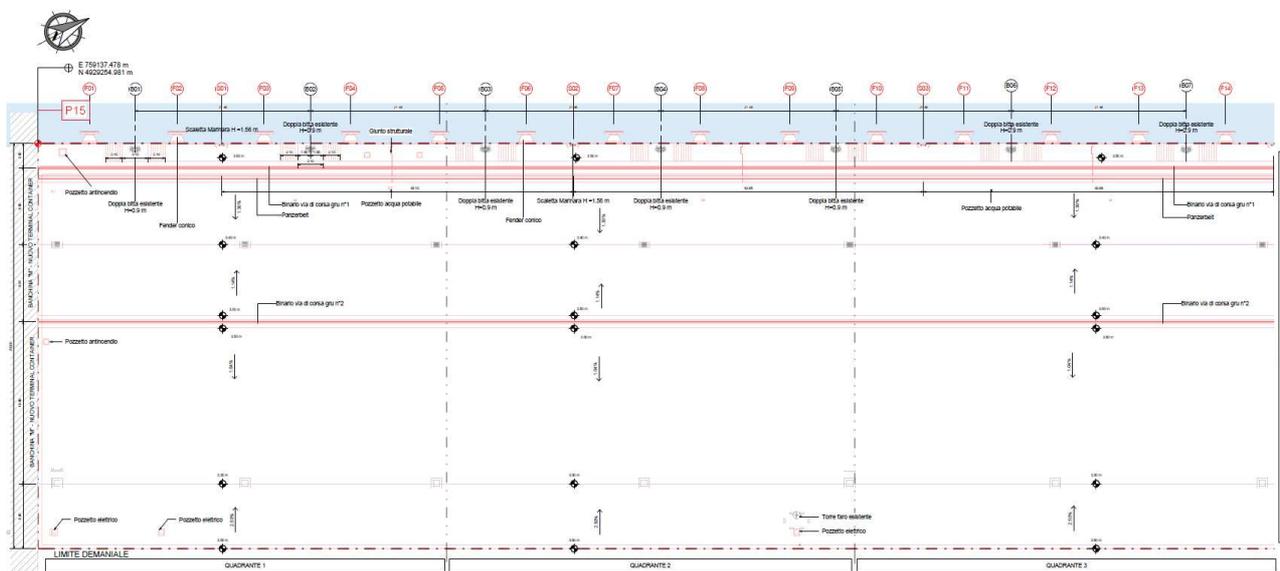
N1 – Planimetria di progetto / Quadranti 1-2-3.
